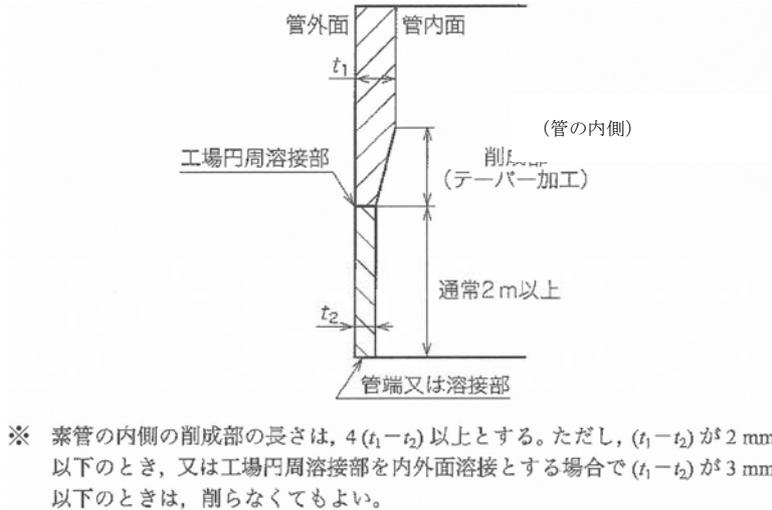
断面変化部の構造（杭基礎設計便覧, 図-III. 2. 50, H27. 3, 日本道路協会）
